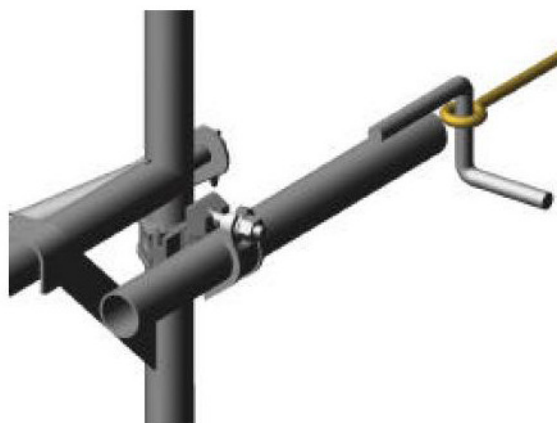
Detalle de un ejemplo de arriostrado a fachada del sistema de andamio, mediante anclaje mecánico y acoplamiento giratorio.
